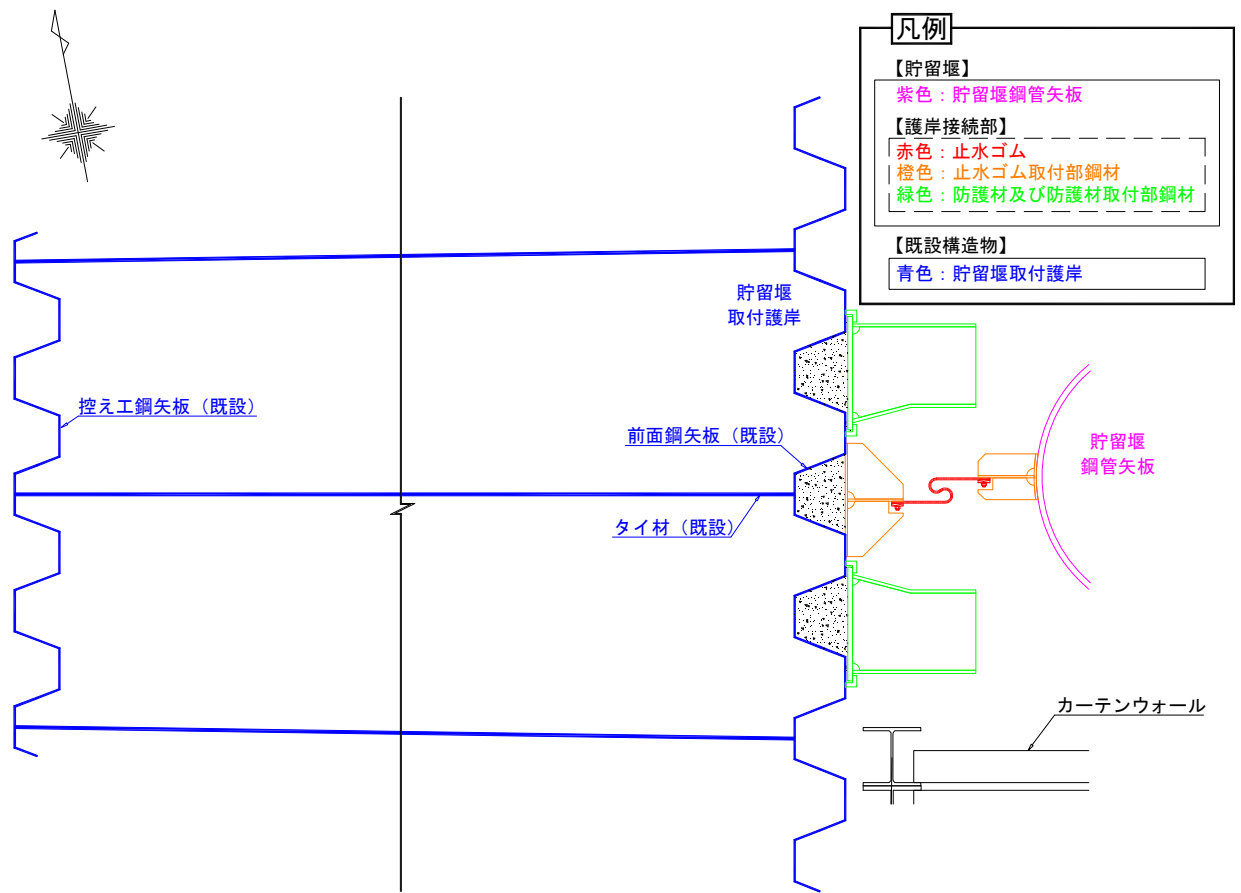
(2) 貯留堰の平面図 (A 部拡大)
